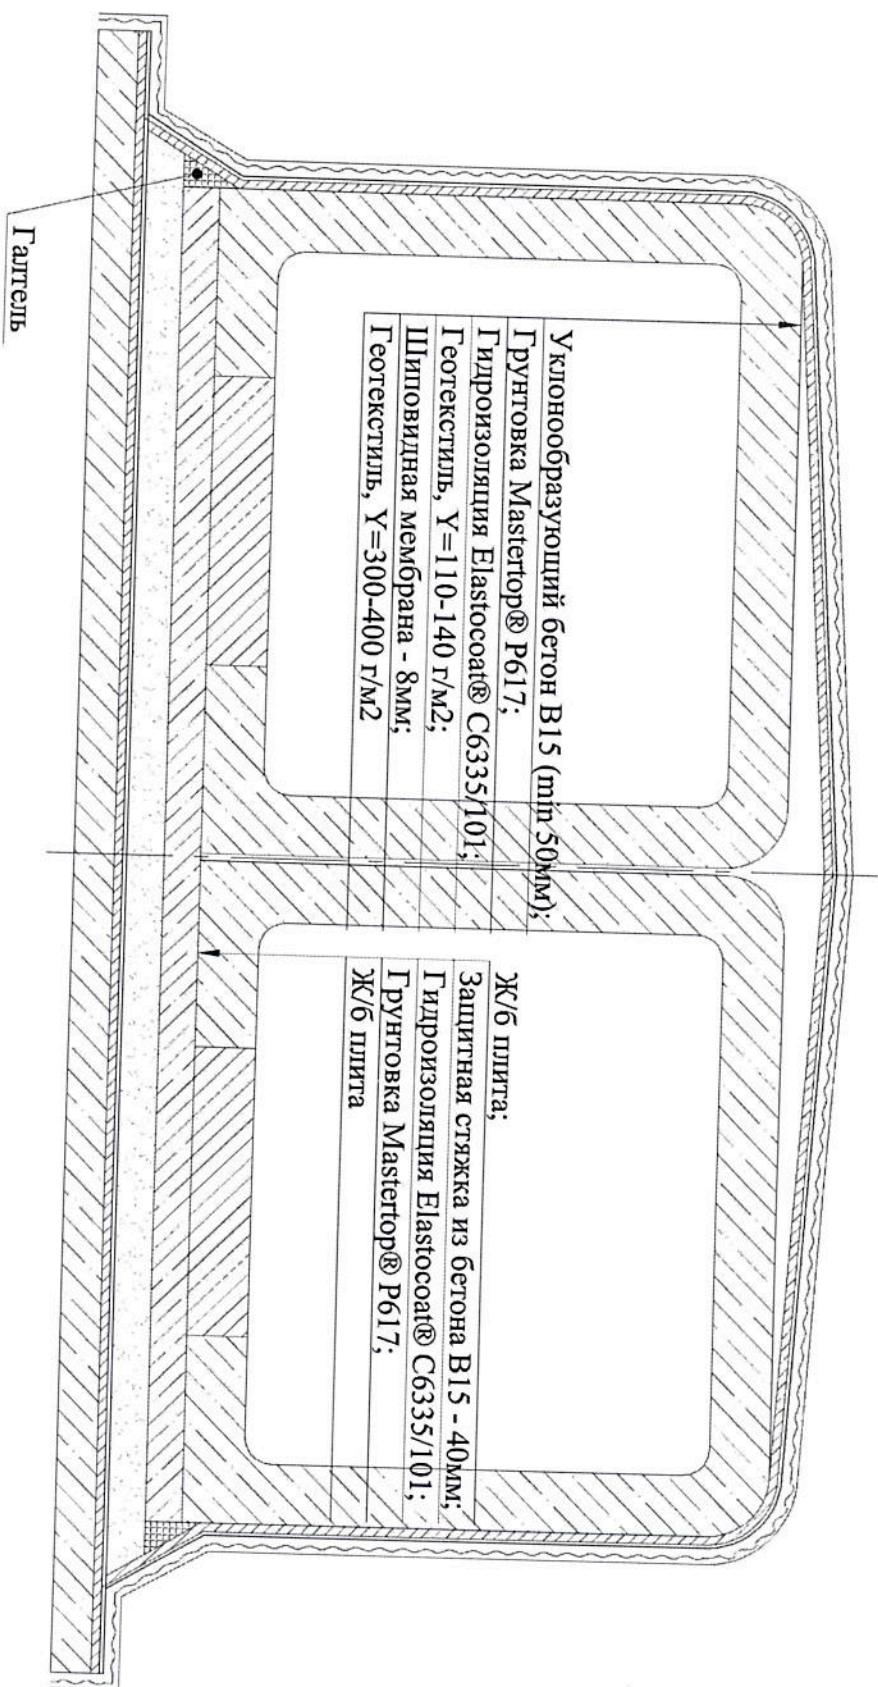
Конструктивное решение гидроизоляции тоннеля
